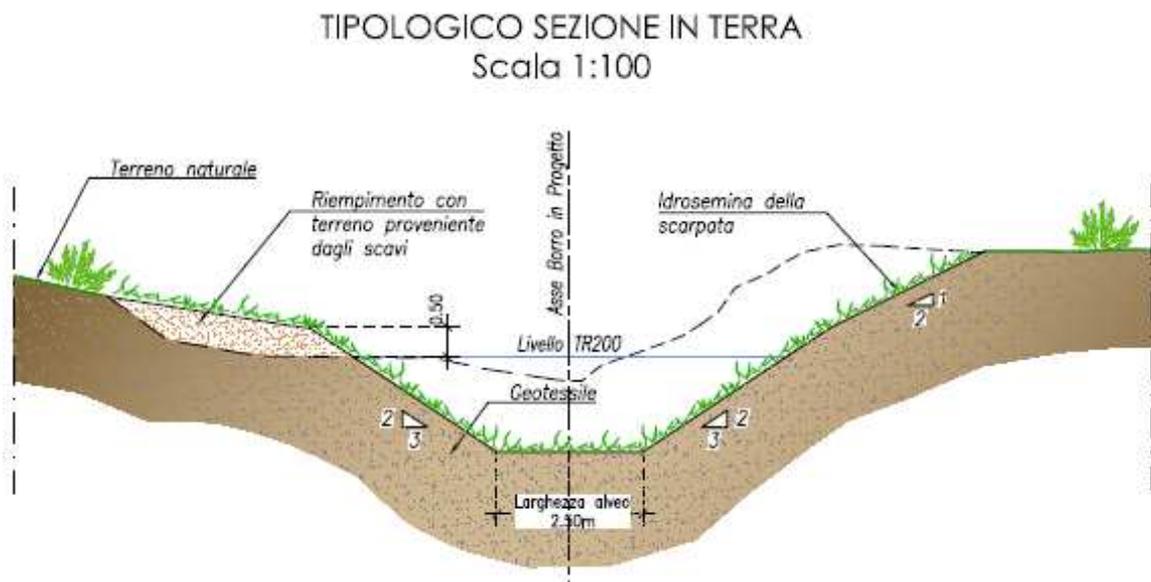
Sezione tipo canale in terra– Borro Lanzi
